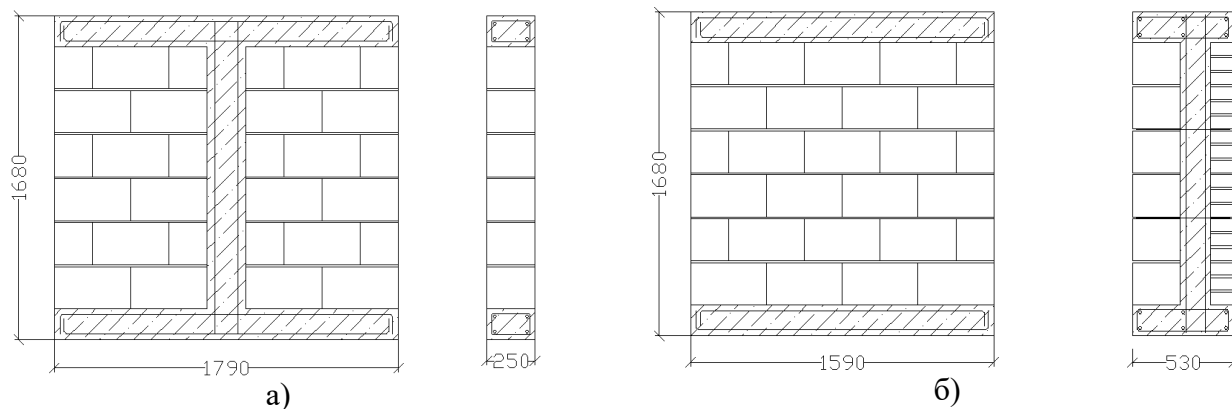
Фрагменты кладки стен для испытаний на «перекос»:
